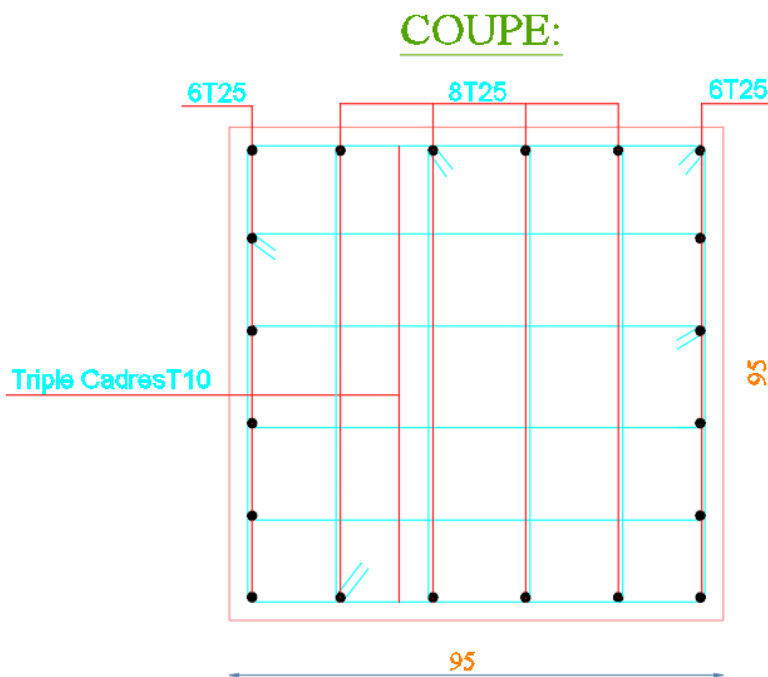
Schéma du ferrailage du poteau (95x95) cm²
